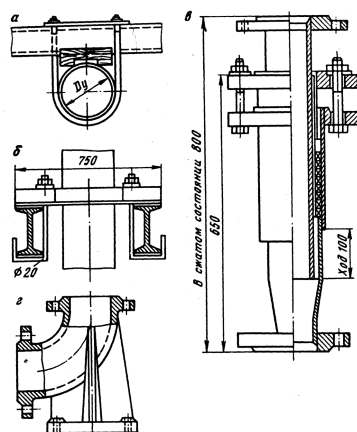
Схема крепления водоотливных труб в стволе: а - трубопровода к расстрелу хомутами через 6-12м, б - трубопровода к вспомогательному расстрелу направляющими хомутами, в - установка сальниково компенсатора, г - установка опорного колена
